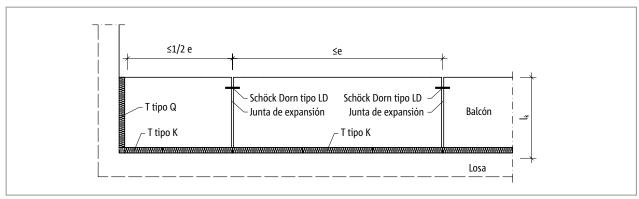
Schöck Isokorb® T tipo K: Disposición de las juntas de expansión
